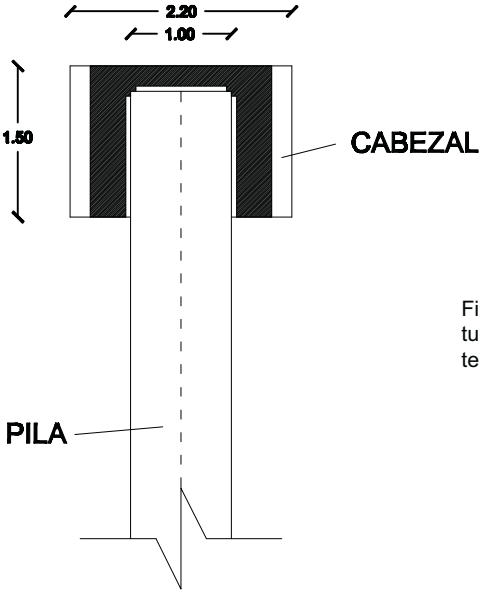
, 215 y 216. C. Asenjo. Esquema de la estructura y el funcionamiento del muelle plataforma y su sistema de unión entre pilas y vigas. 2010.
